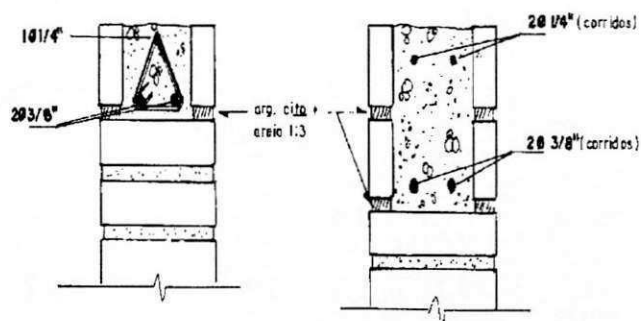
Uso de Canaletas reforçadas com Aço em Alvenaria de Tijolos
